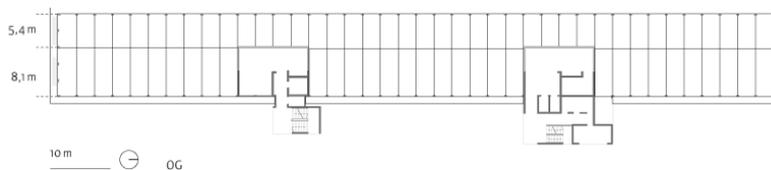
Illwerke Montafon – Grundriss Büroraster¹²⁴
